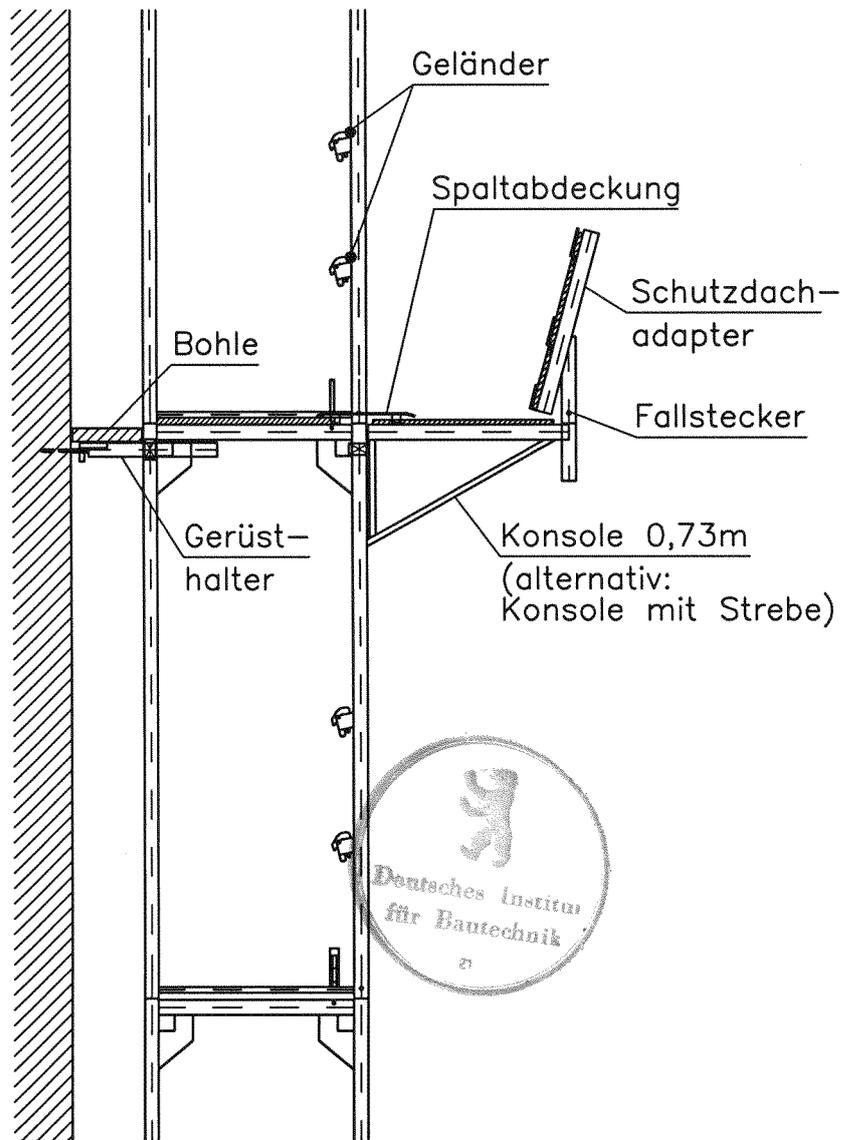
Schutzdach mit Konsolen 0,73 m und Schutzdachadaptern
